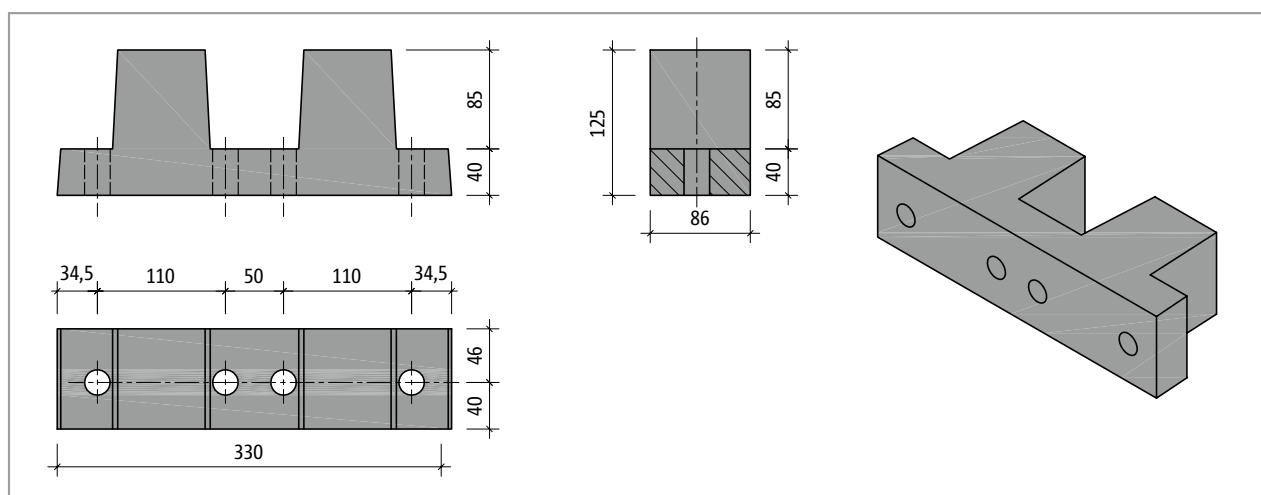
Schöck Isokorb® : élément d'évidement (non fourni par Schöck)
